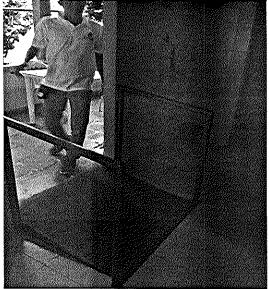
y 49. Colocación de barandas y rampas de acceso
